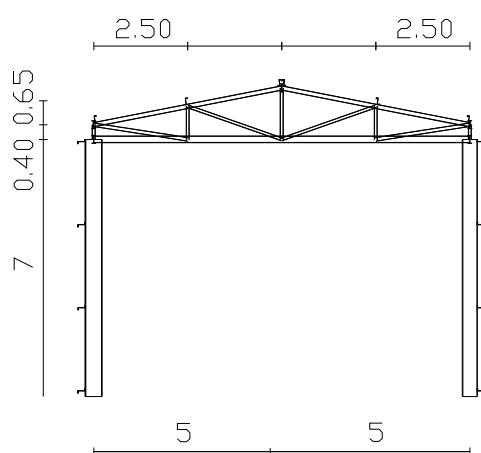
Pórtico com pilar de alma cheia, viga em treliça, vão de 10.00m
